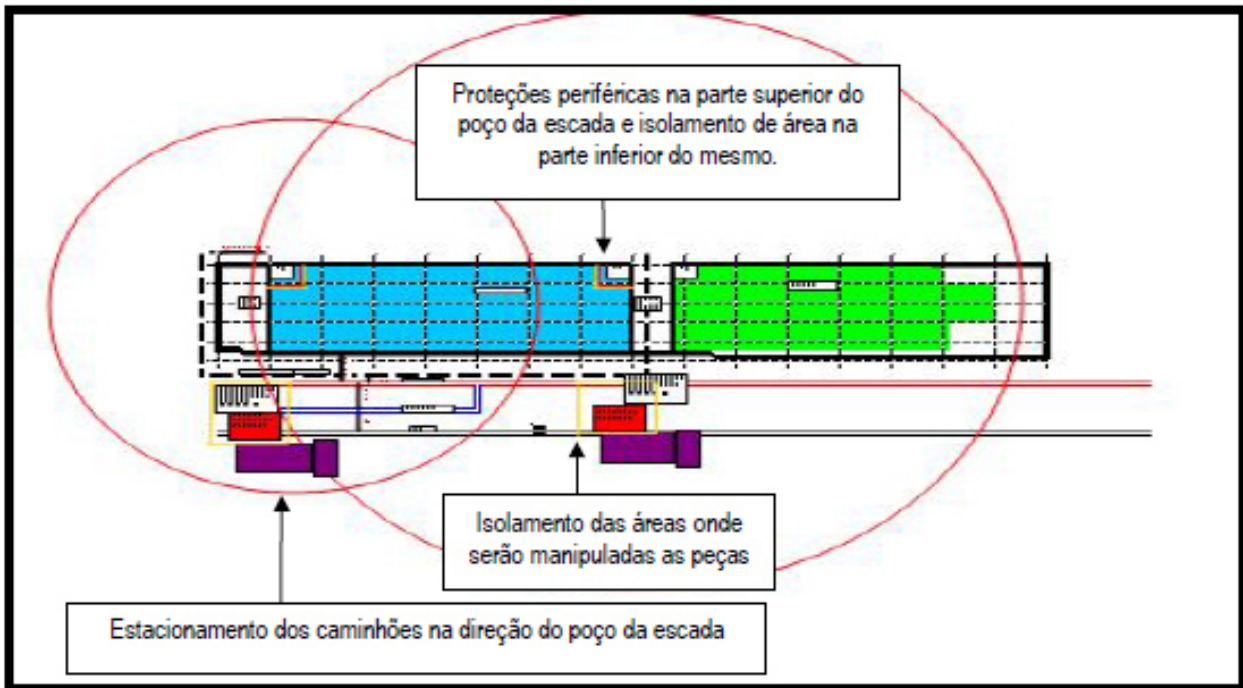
Plano de proteções coletivas para instalar as escadas pré-fabricadas
